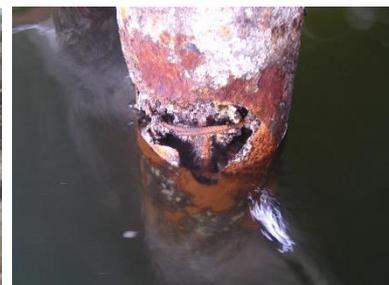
Estaca metálica preenchida com concreto armado – Note-se corrosão e ruptura no tubo metálico e a presença de falha de concretagem no interior do elemento estrutural
